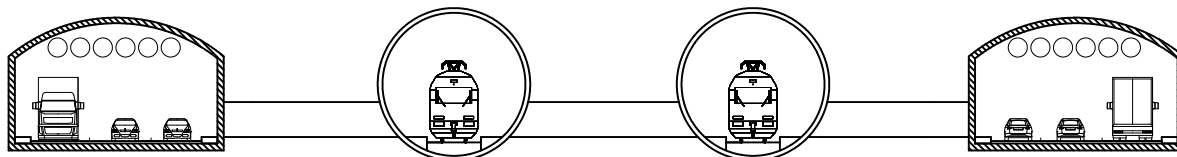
Tunnel mixte ferroviaire routier profond.
